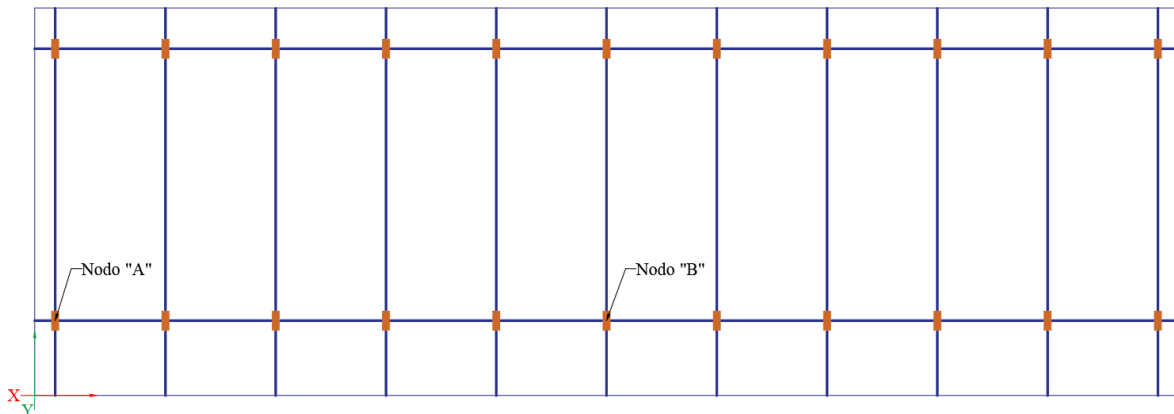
Vista en planta de la azotea con la localización de los nodos de control.
